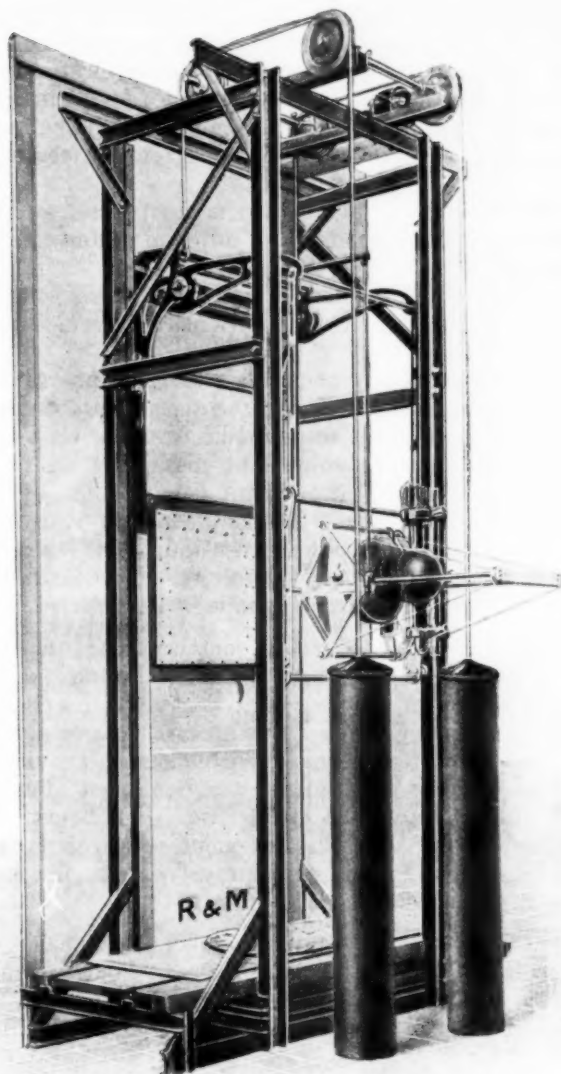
Appareil vu postérieurement; les murs opaques ont été supprimés sur le dessin.
